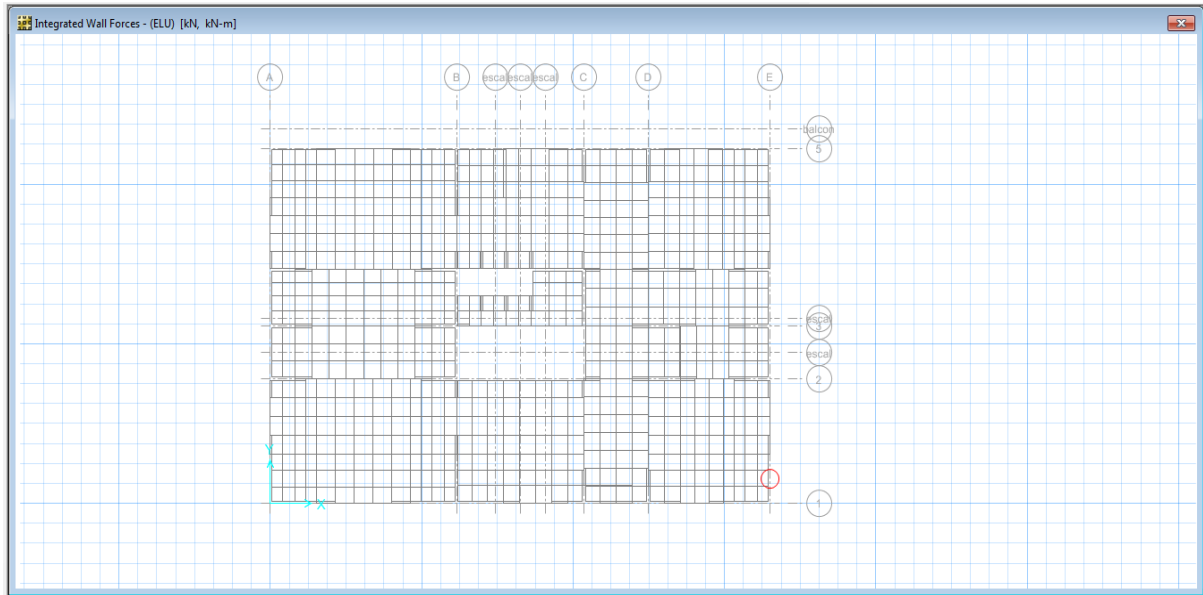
Schéma du Plancher Haut Sous /Sol
